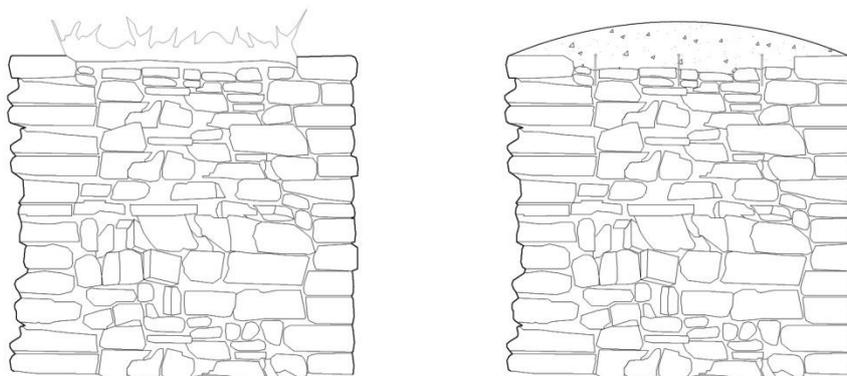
Protezione delle creste murarie attraverso il bauletto
